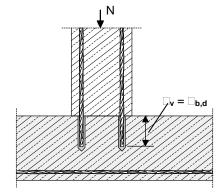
Recouvrement d'armatures pour la iaison de dalles et poutres
